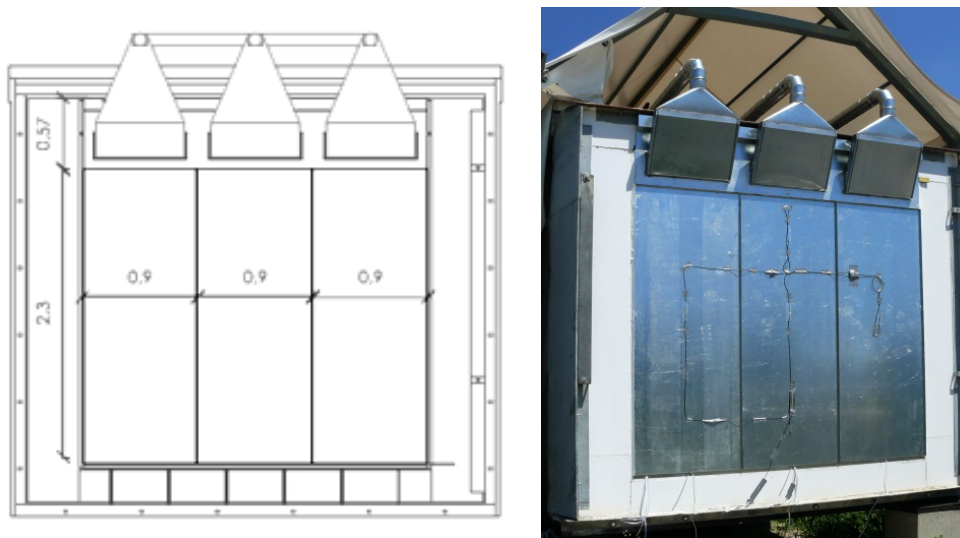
Diseño de probeta de ensayo y muestra final
